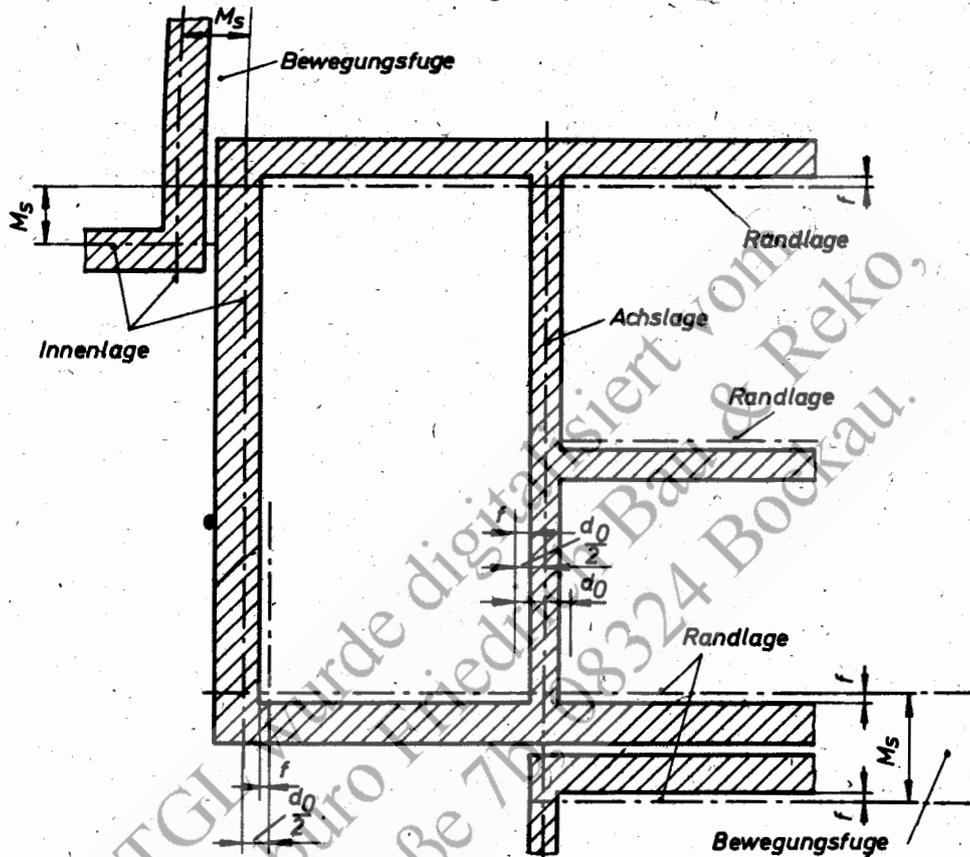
Zuordnung einer Wandkonstruktion zu den Systemlinien im Grundriß
